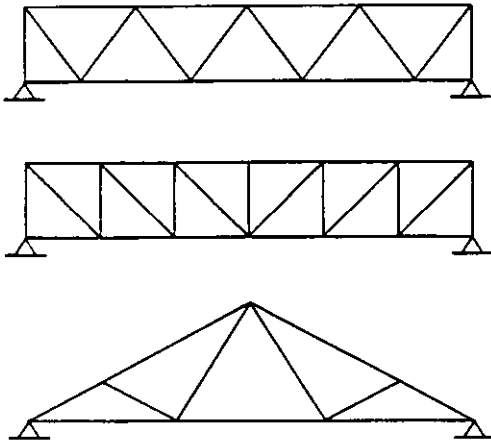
Armaduras para puentes y edificios urbanos o industriales.
